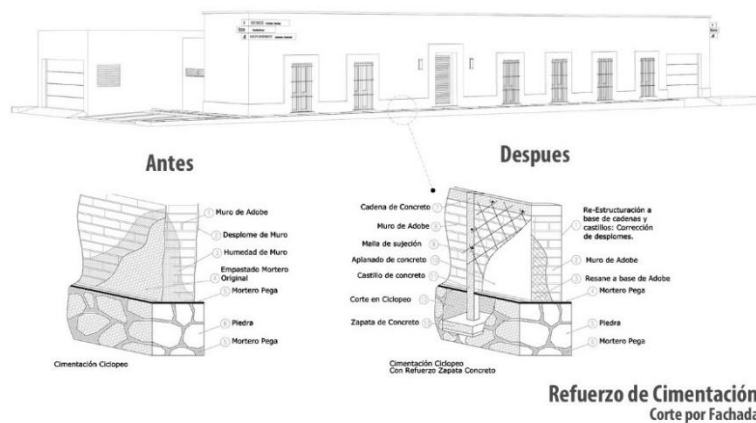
Detalle de corte de fachada, refuerzo de cimentación. Fuente: Archdaily
